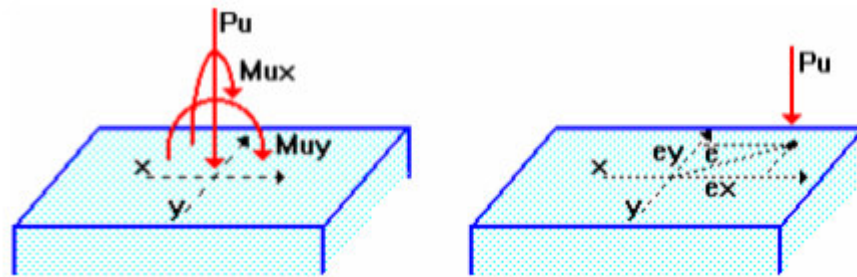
Flexo compresión biaxial en columnas (Romo, Temas de hormigón armado, 2008)
